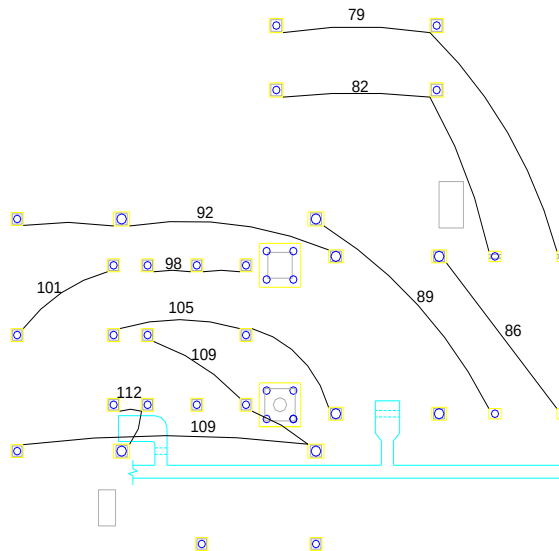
Planta esquemática de distribuição dos recalques na área da caldeira.
